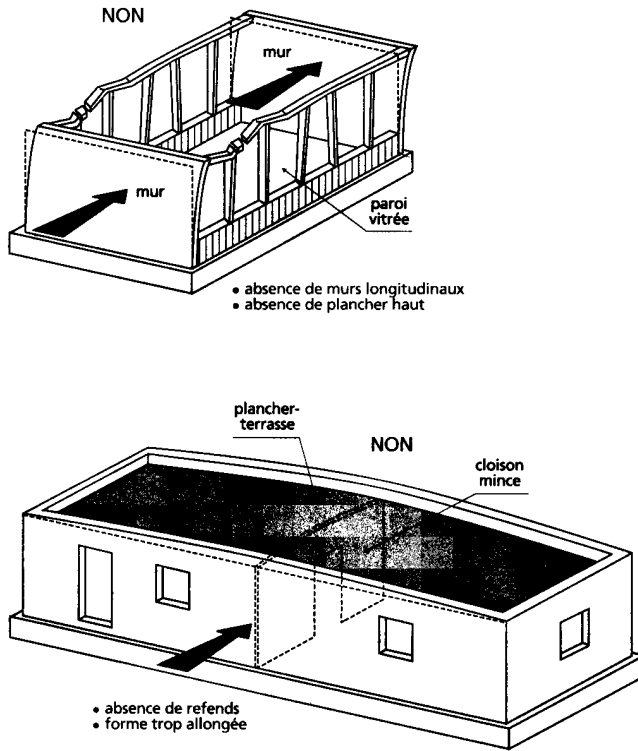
Constructions dont la résistance aux séismes est faible (Zacek, 1996)
